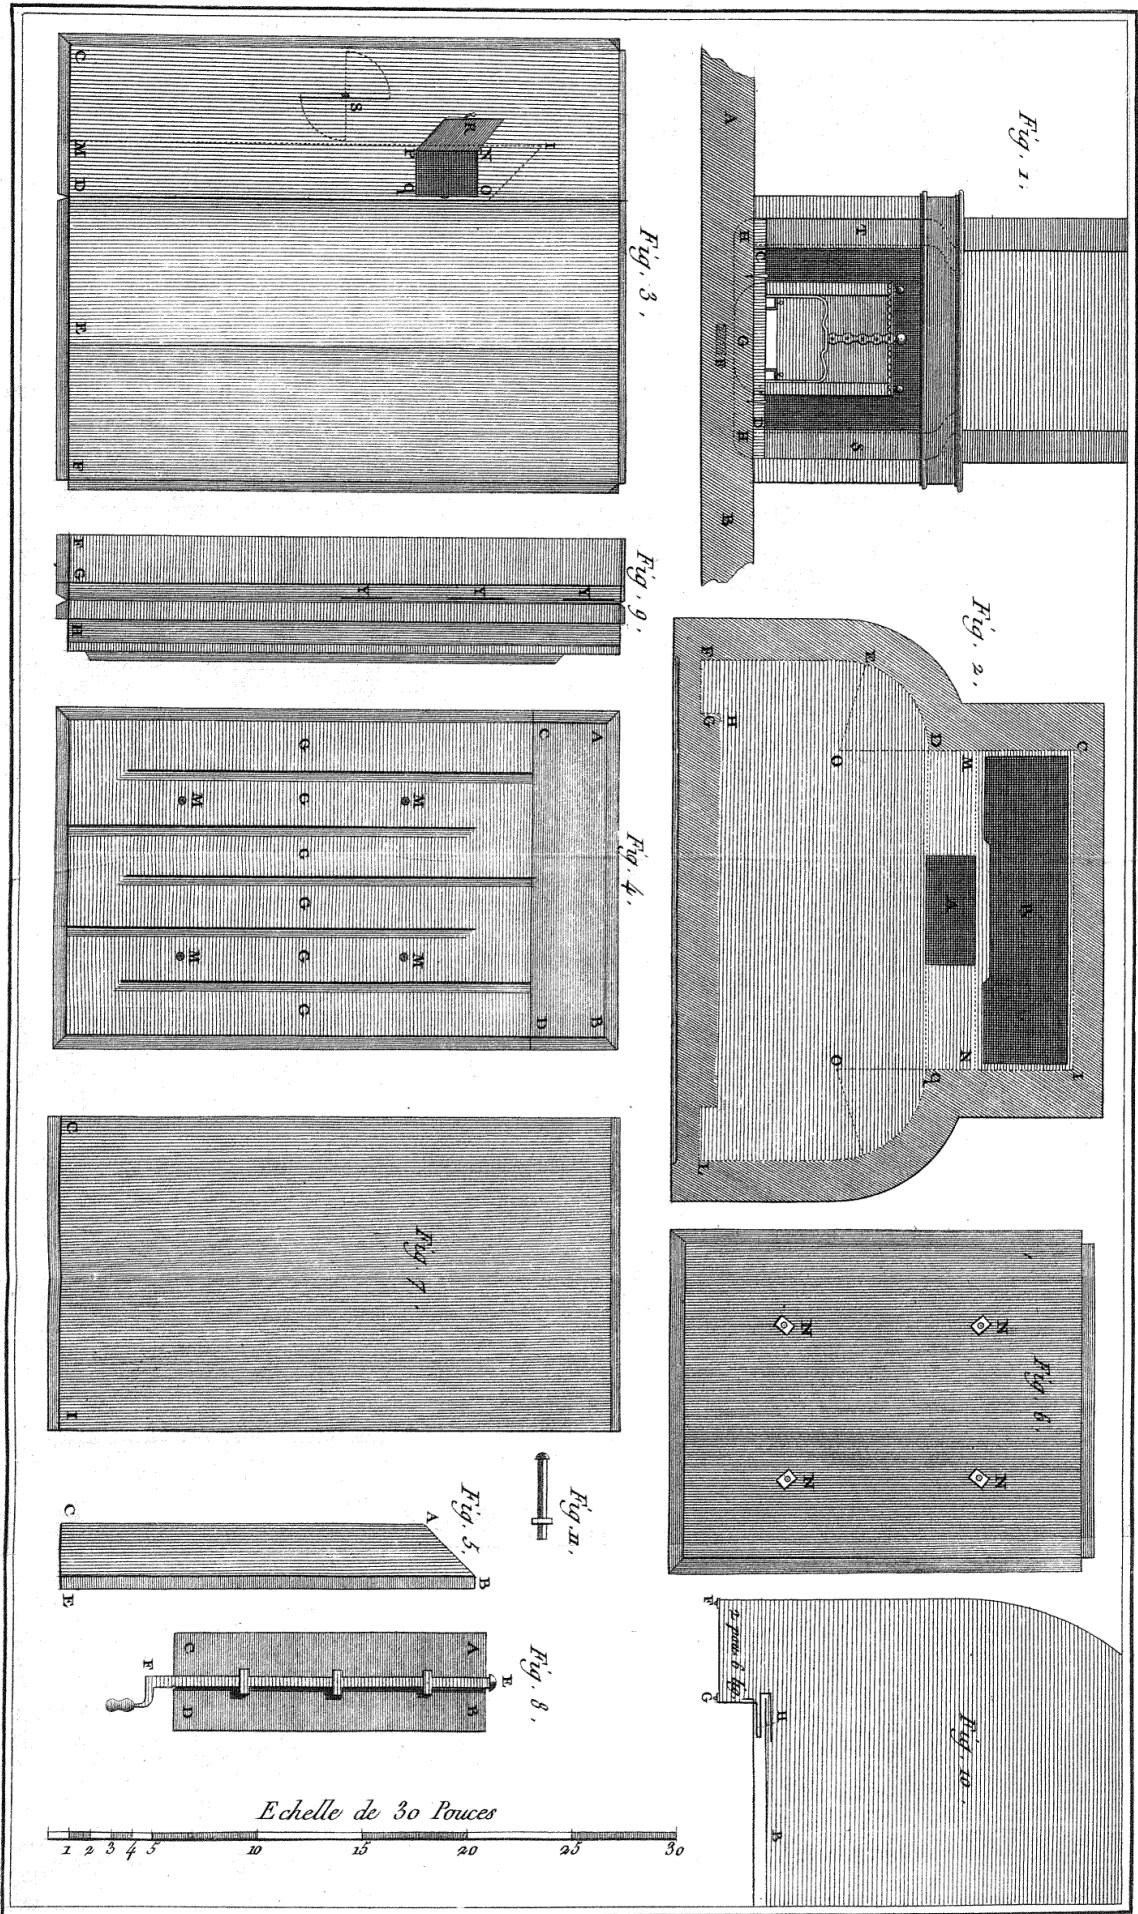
Vue d'une Cheminée placée contre un mur A entre deux pilastres B. L'air échauffé fort à travers une pyramide à jour, posée sur le comble.
